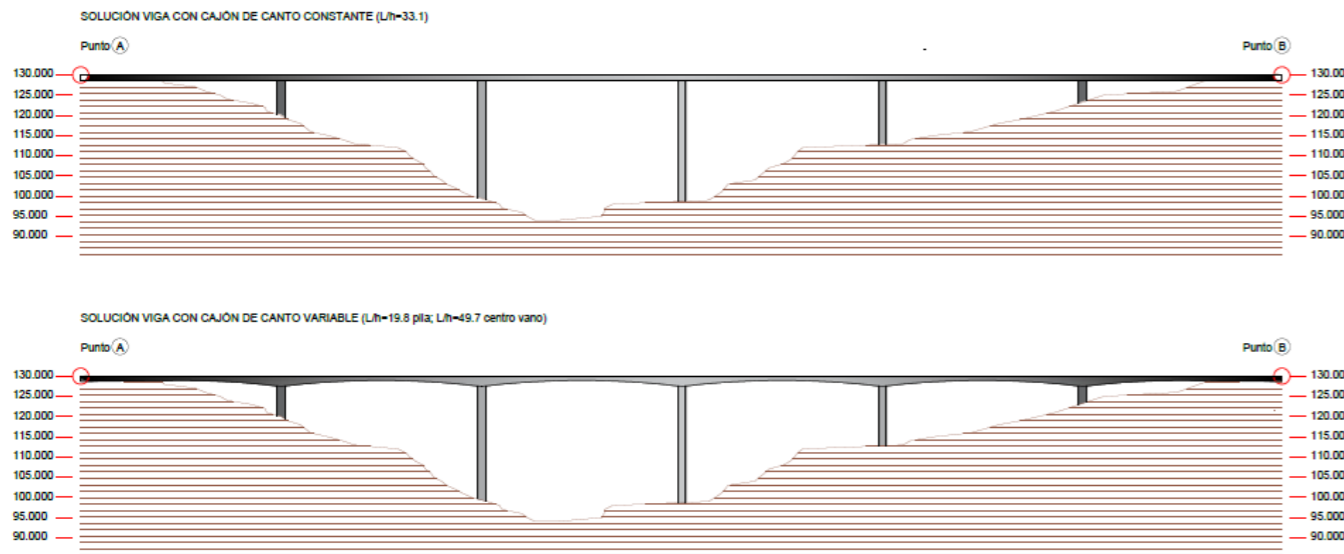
Alzado para soluciones viga en cajón de canto constante y canto variable. Fuente: Elaboración Propia (AutoCAD)
